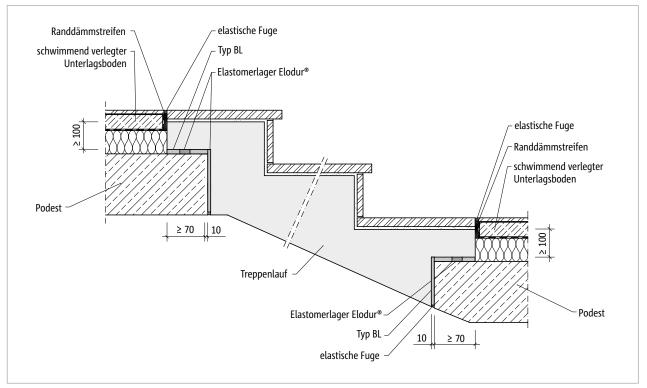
Schöck Tronsole® Typ BL: Einbauschnitt
